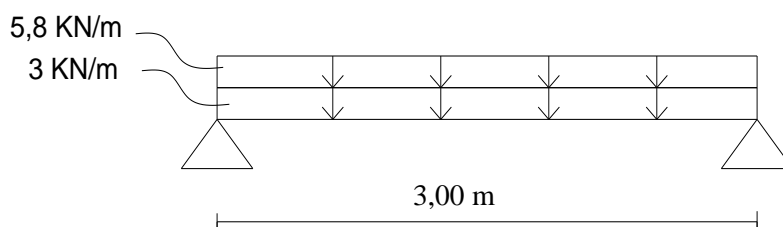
Poutre en béton armé de barres de PRFV bi-articulée [15] - (Concrete beam reinforced with GFRP bars simply supported)
